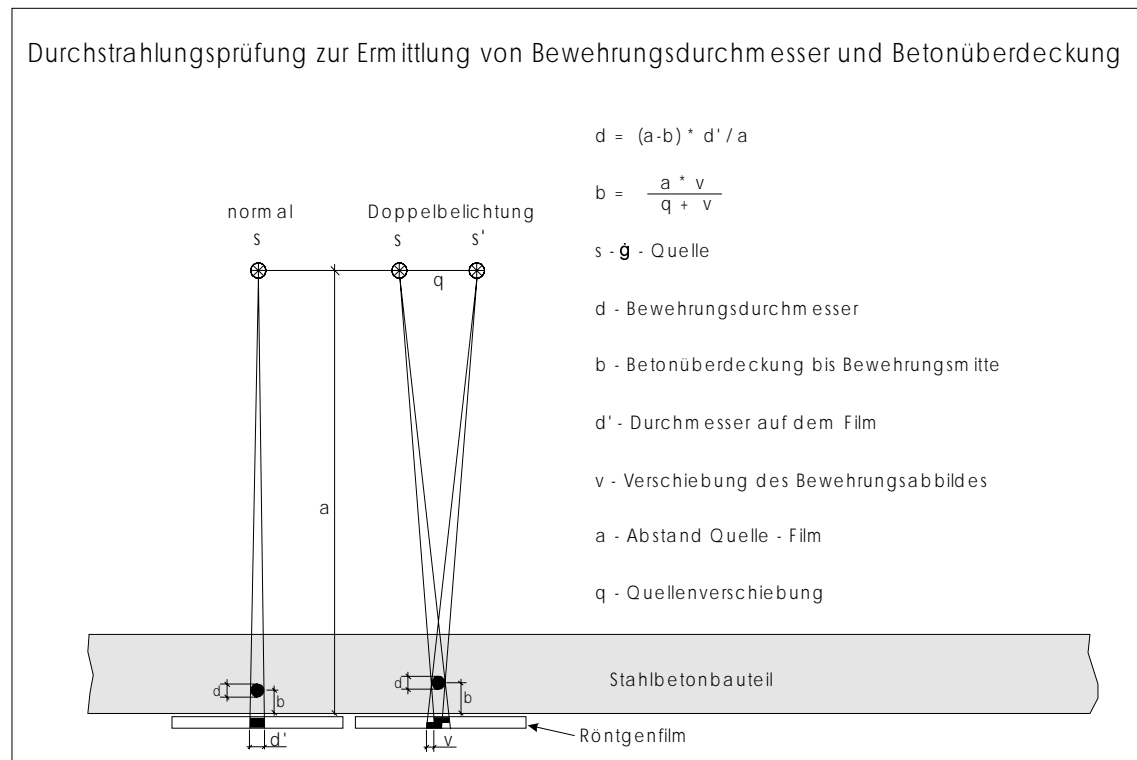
Ermittlung von Durchmesser und Betonüberdeckung der Bewehrung mittels Durchstrahlungsprüfung
